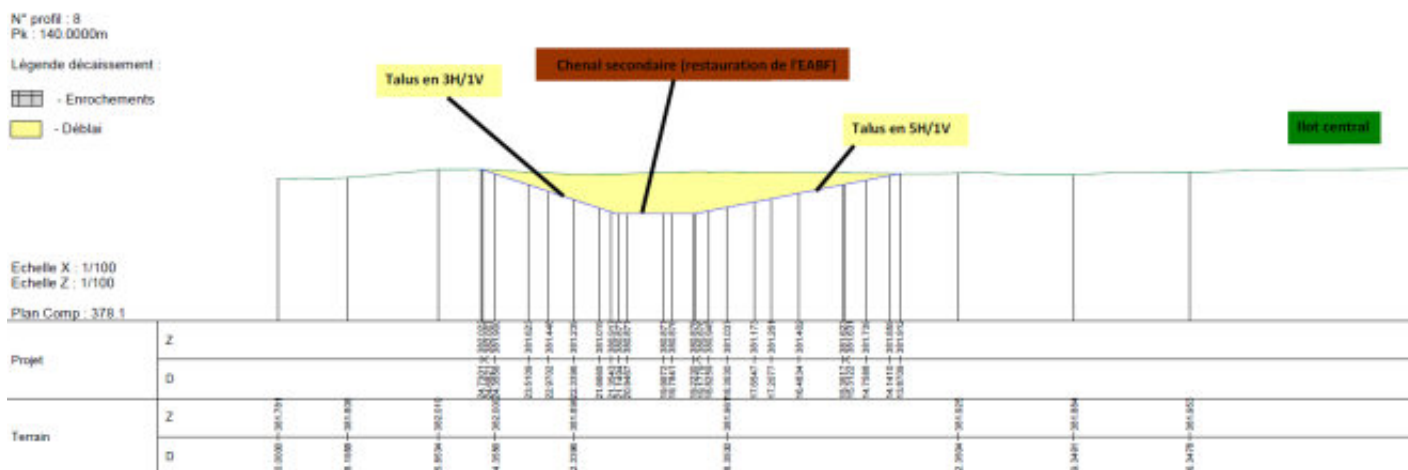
Profil en travers du chenal secondaire extrait des plans
